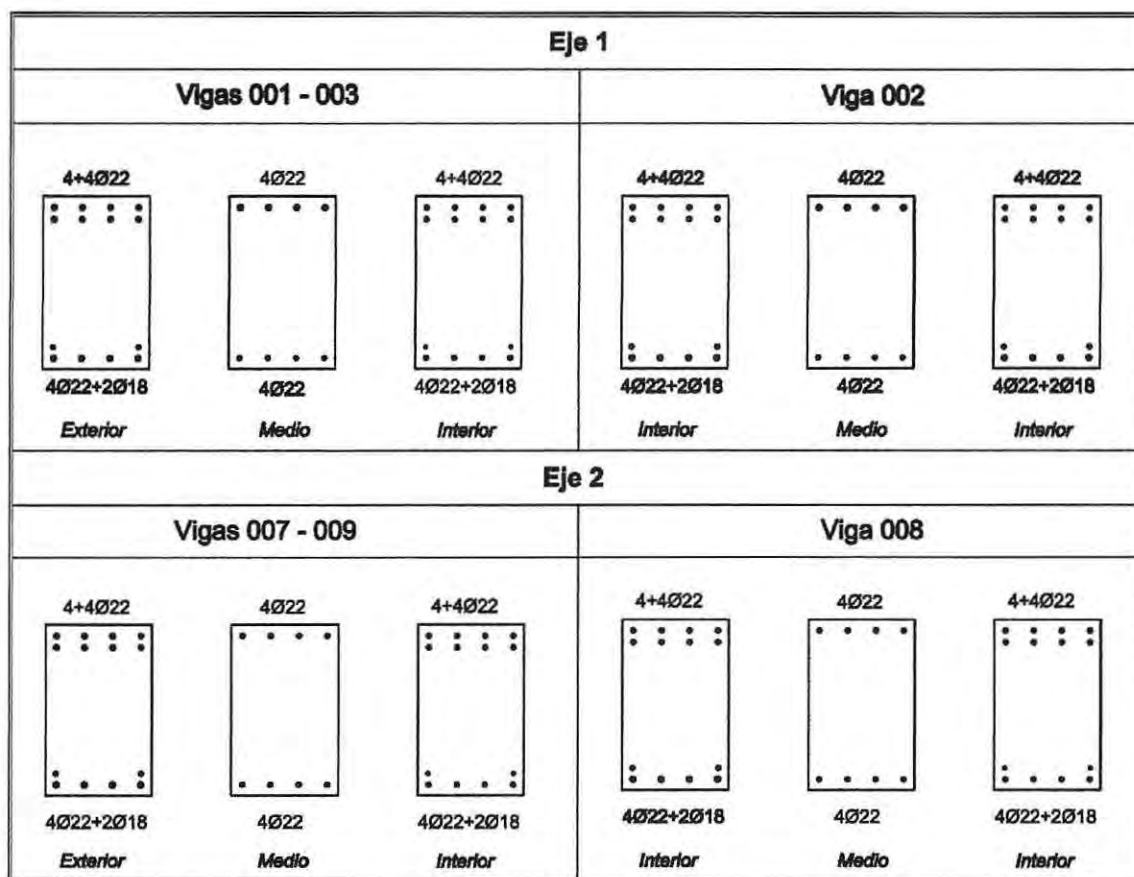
Armadura a flexión de vigas en estructura con marcos, Ejes 1 y 2.
